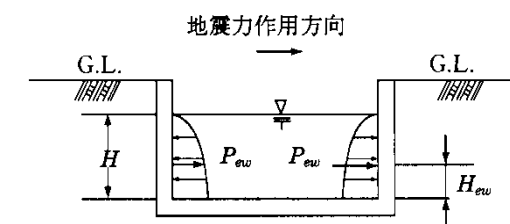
矩形構造物 (自由水面有り) に作用する動水圧 (Westergaard法)
